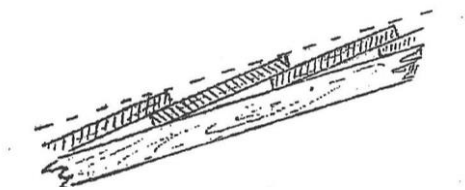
Croquis de disposición de las tejas sobre la cubierta de madera. Fuente: (Anónimo, 1909).
